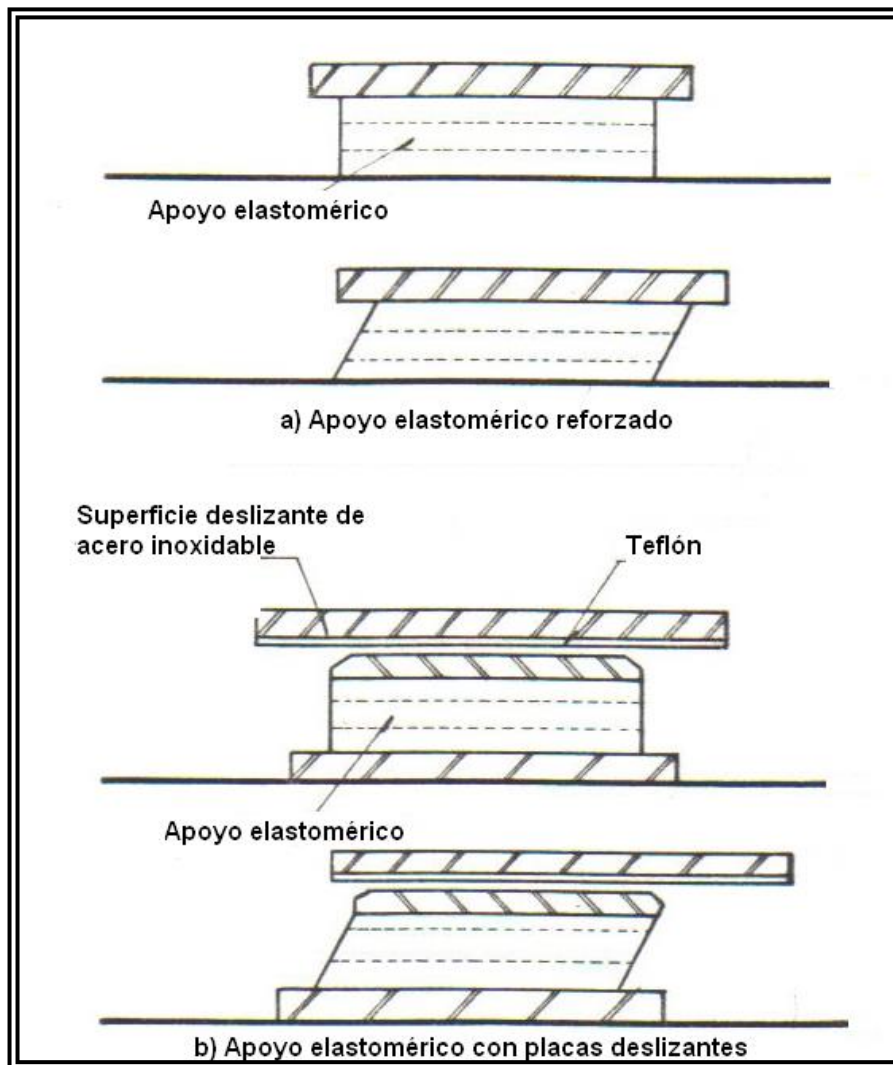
59 a) Apoyo elastomérico reforzado, b) Apoyo elastomérico con placas deslizantes; en la primera figura de cada tipo observamos el apoyo sin deformar, mientras en la segunda el apoyo sometido a cargas.⁸⁵
